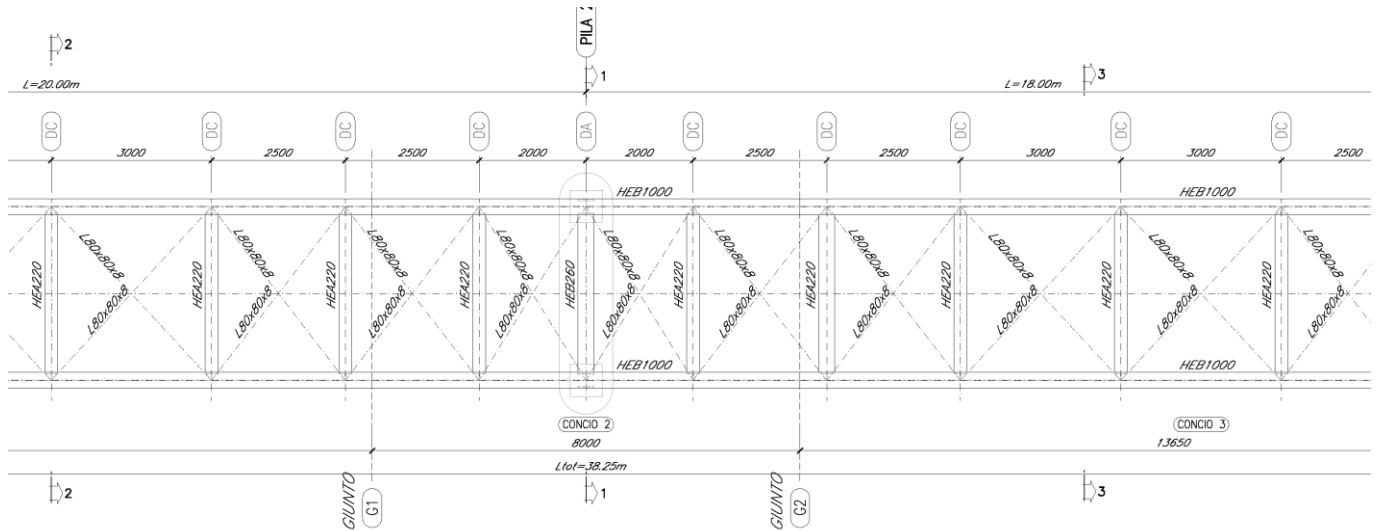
Pianta impalcato in carpenteria metallica (stralcio) [mm]
